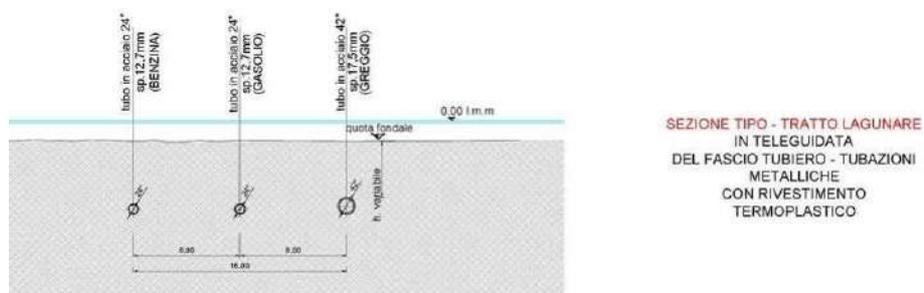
Fascio tubiero – tratto lagunare – sezione di posa.
